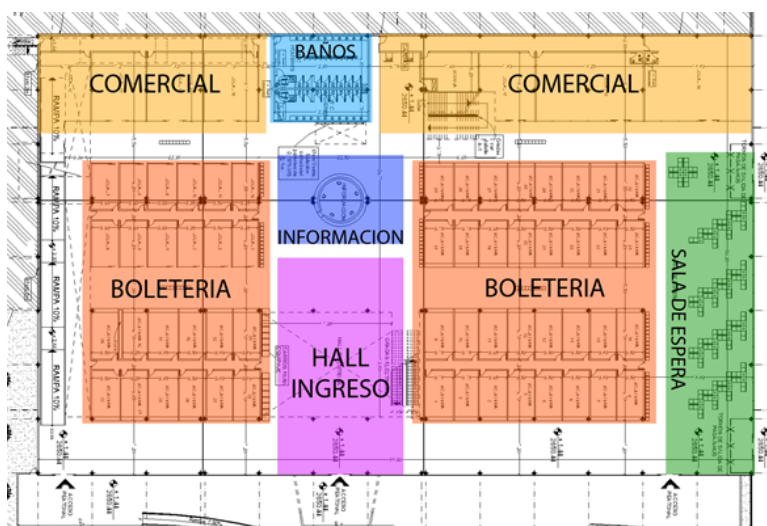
Zonificación de planta baja, edificio principal del terminal sur de Ambato.
